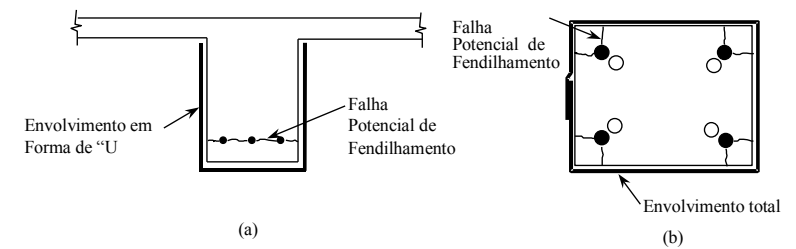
Reforço com fibras utilizado para grampear o comprimento de ancoragem das barras longitudinais. (a) para envolvimento em “U” de seção de viga. (b) para envolvimento total utilizado para uma seção de coluna/pilar.
